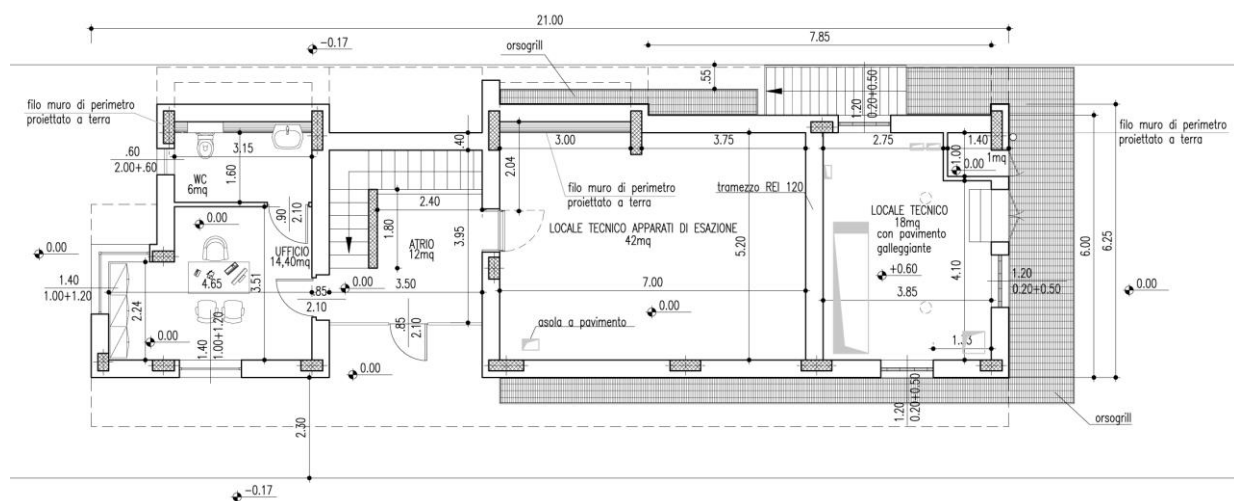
Pianta Piano Terra Fabbricato di Casello
